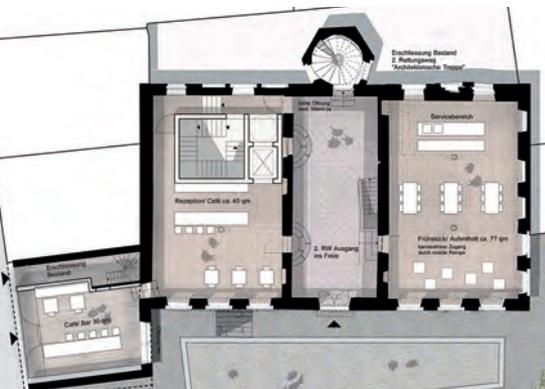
Grundriss EG Hotel und Gastronomie
